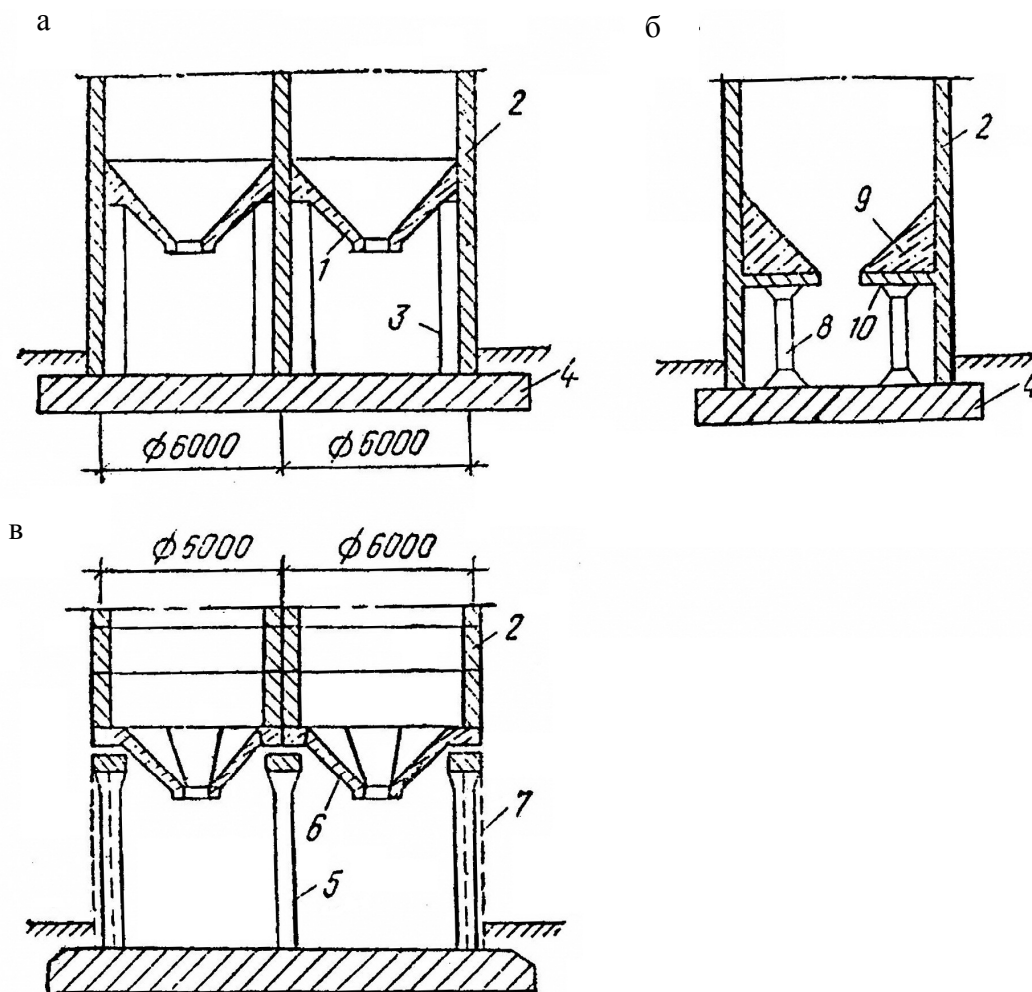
Конструктивные схемы опирания цилиндрических силосов: а – монолитных с монолитными воронками; б – монолитных с плоским дном; в – сборных со сборными воронками; 1 – монолитная воронка; 2 – стены силосов; 3 – пилястры; 4 – фундаментная плита; 5 – П-образные рамы; 6 – сборная воронка; 7 – стенное ограждение; 8 – колонны; 9 – забутка; 10 – плоское дно
